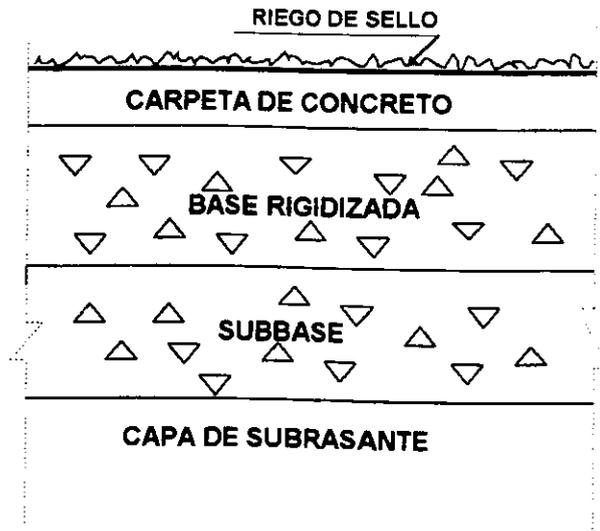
CAPAS QUE FORMAN UN PAVIMENTO FLEXIBLE
